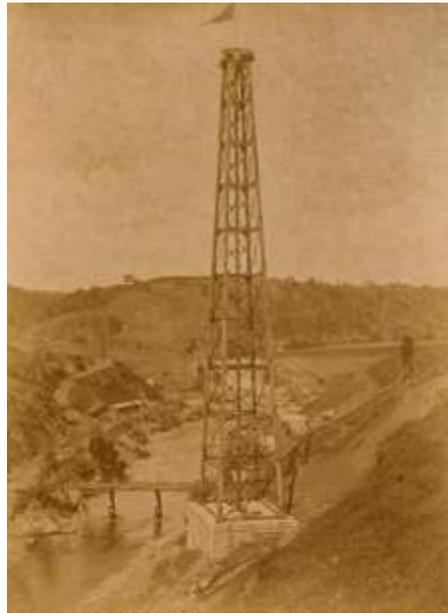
Construcción de las torres sobre las pilas del viaducto Malleco, 1888.
